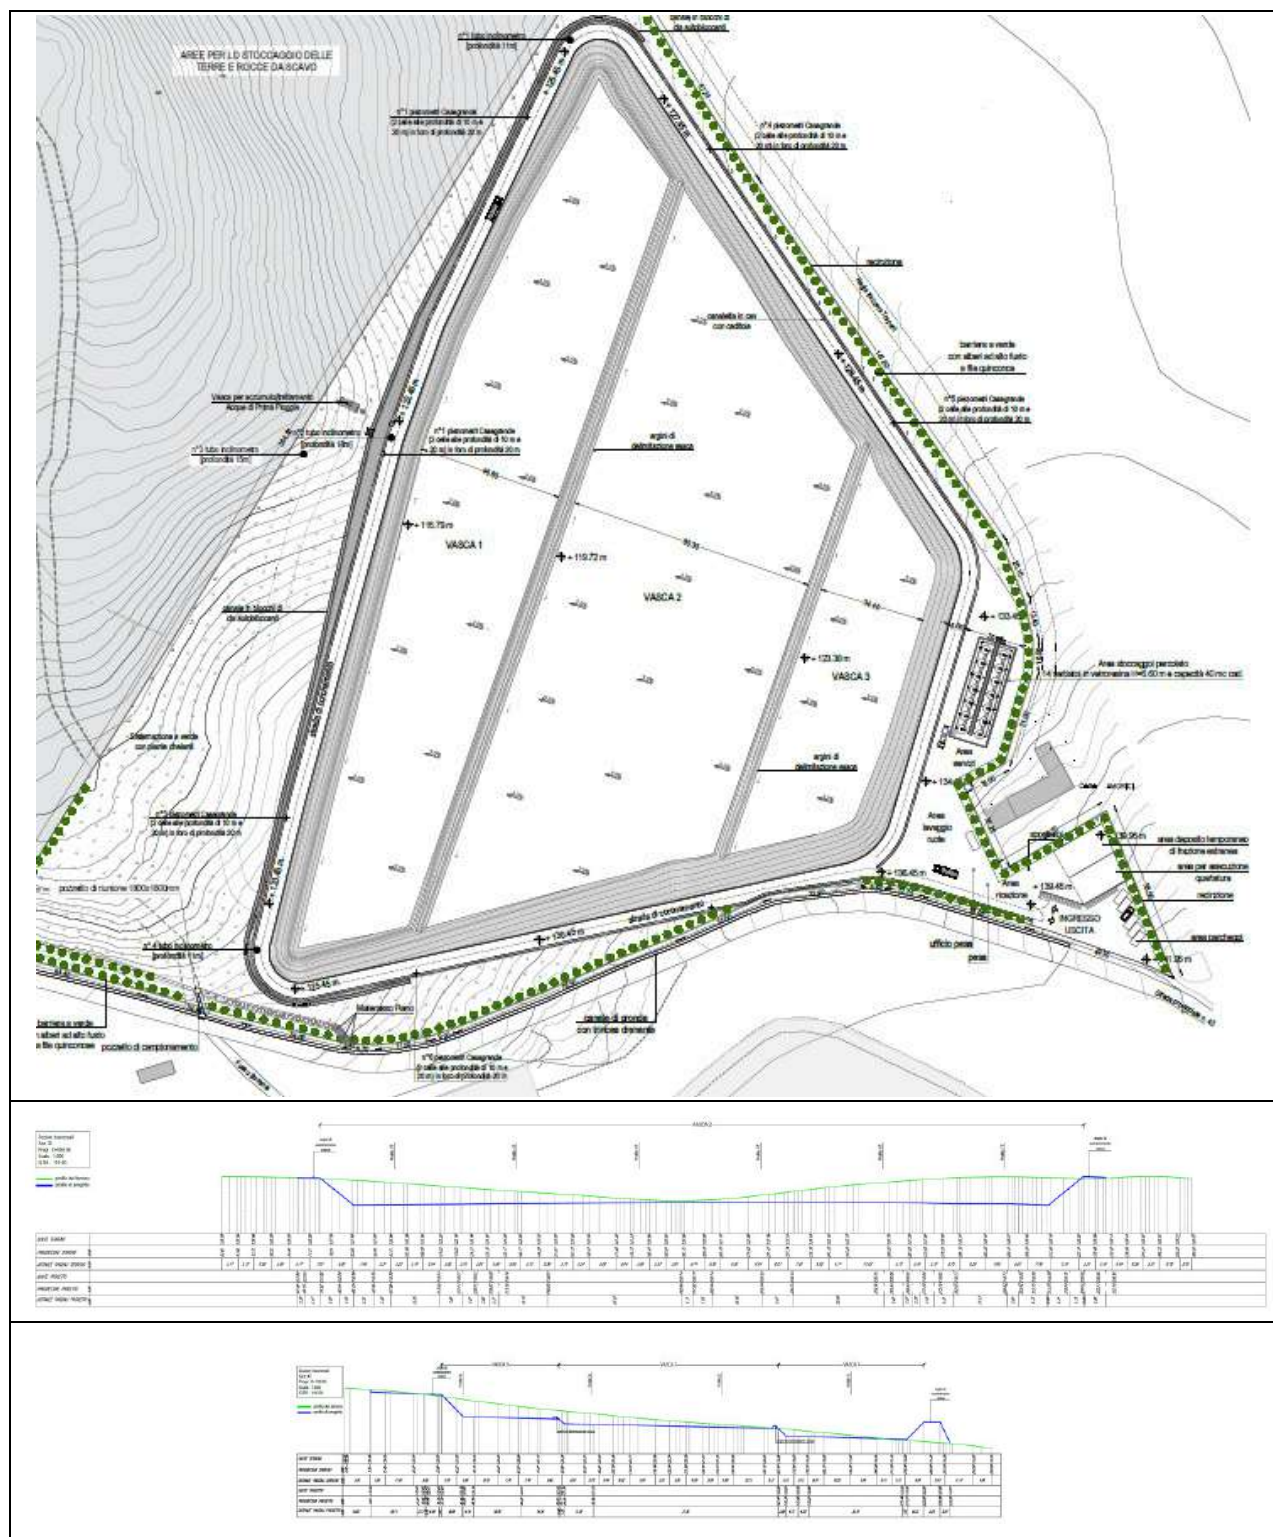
pianta della vasca e sezioni tipo longitudinale e trasversale (di progetto)
